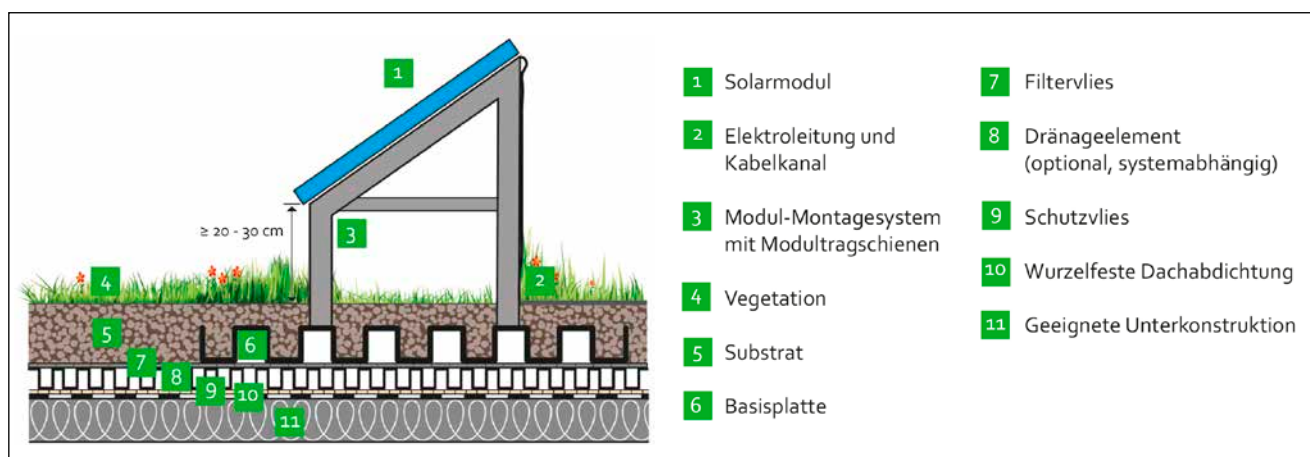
Schematischer Schnitt durch ein auflastgehaltene Solar-Gründach. Der Gründachaufbau hält die PV-Aufständerung lagesicher und ohne Dachdurchdringung
